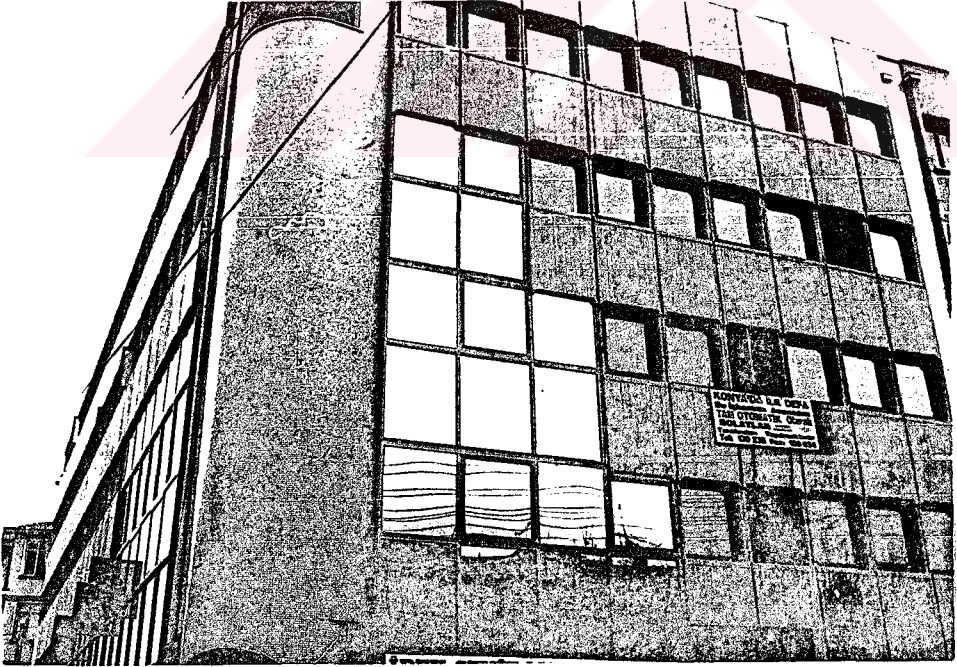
Prefabrike Beton Cephe Uygulama Örneği
